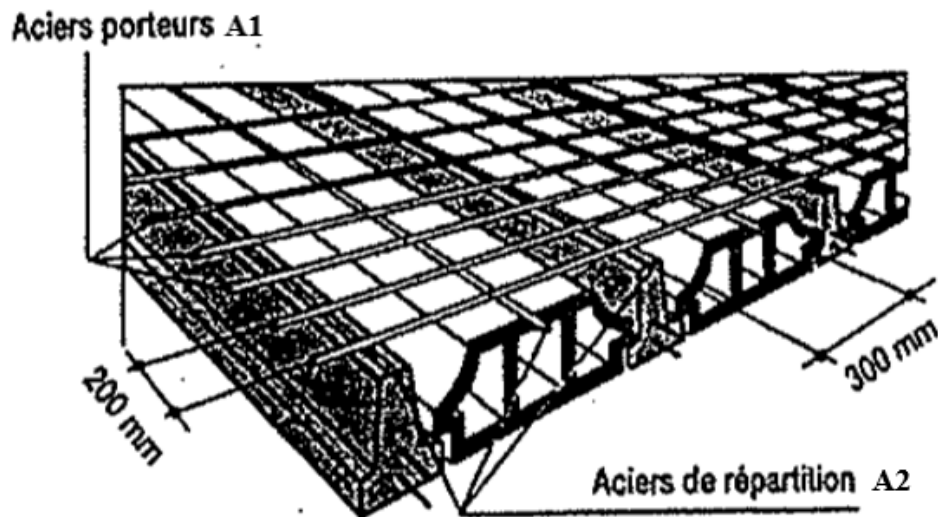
Ferrailage d'une dalle à corps creux [6].
